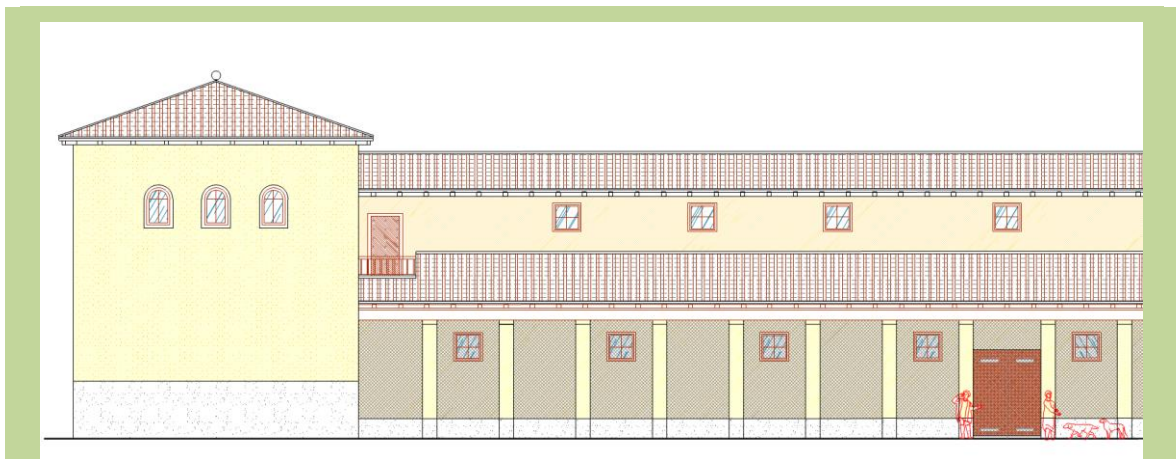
Detalle de la fachada norte de la zona residencial de la villa -I- (reconstrucción virtual). CGS.
